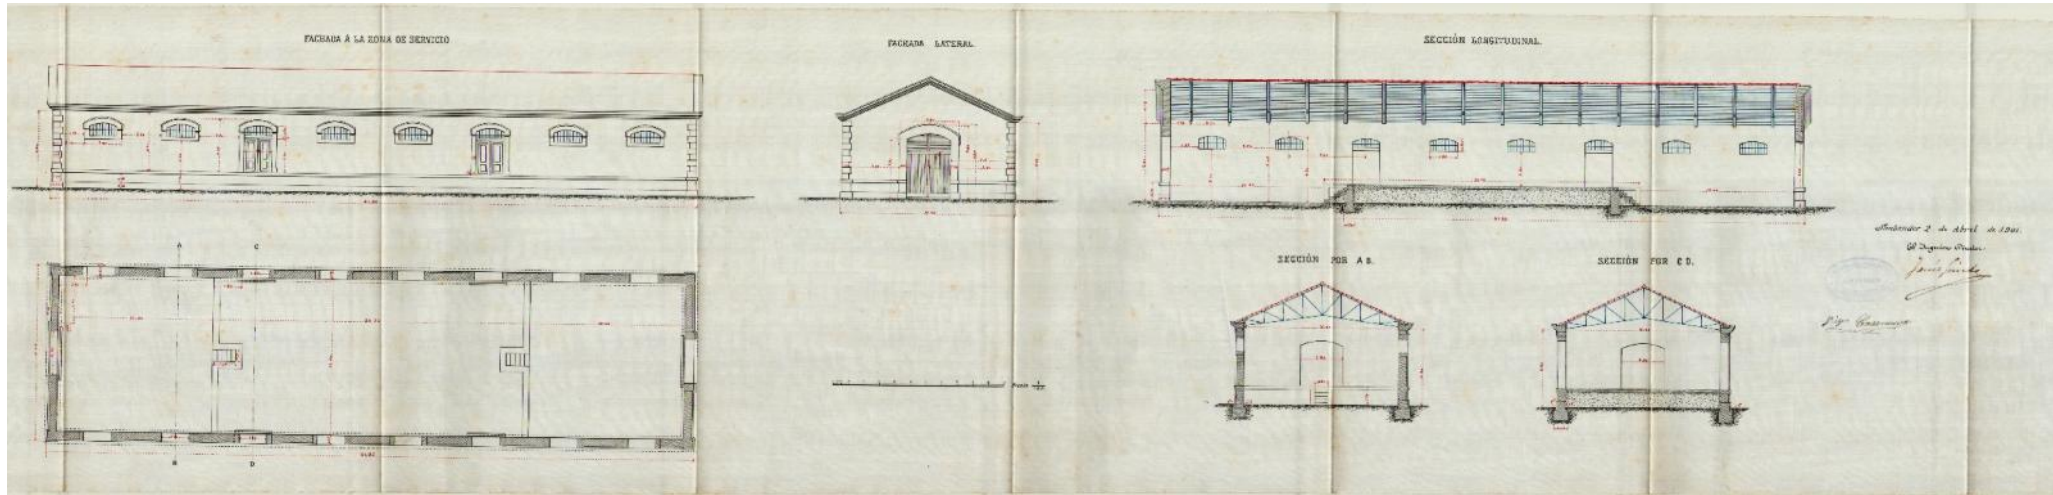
Hoja 1ª: Alzados, plantas y secciones. Contenido en el Proyecto de 1901.
